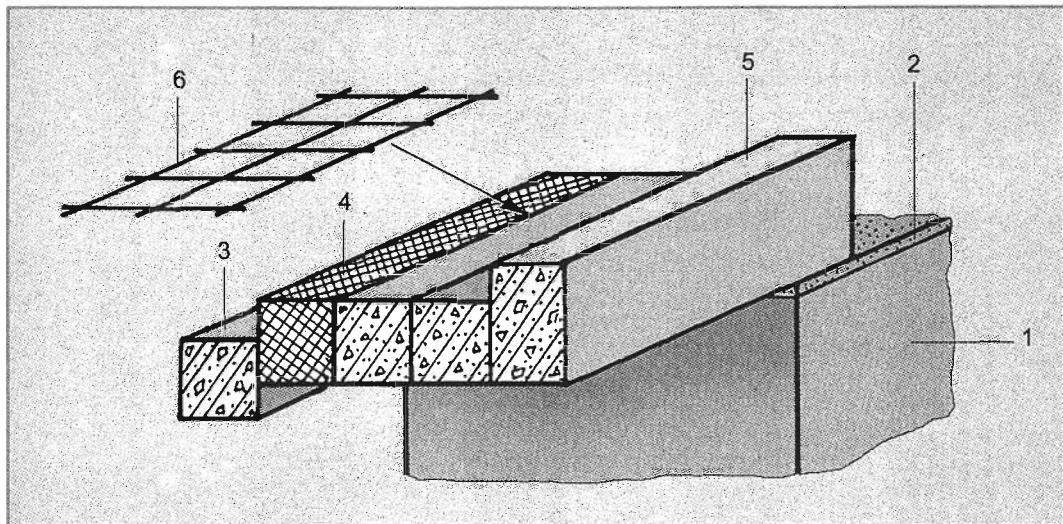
Прерывание мостика холода в сборной железобетонной перемычке: 1 – кирпичная стена; 2 – растворная постель; 3 – рядовая железобетонная перемычка; 4 – вкладыш из жесткого утеплителя ($P = 100\text{--}200 \text{ кПа}$); 5 – усиленная железобетонная перемычка; 6 – арматурная сетка ($d = 3\text{--}4 \text{ мм}$)
